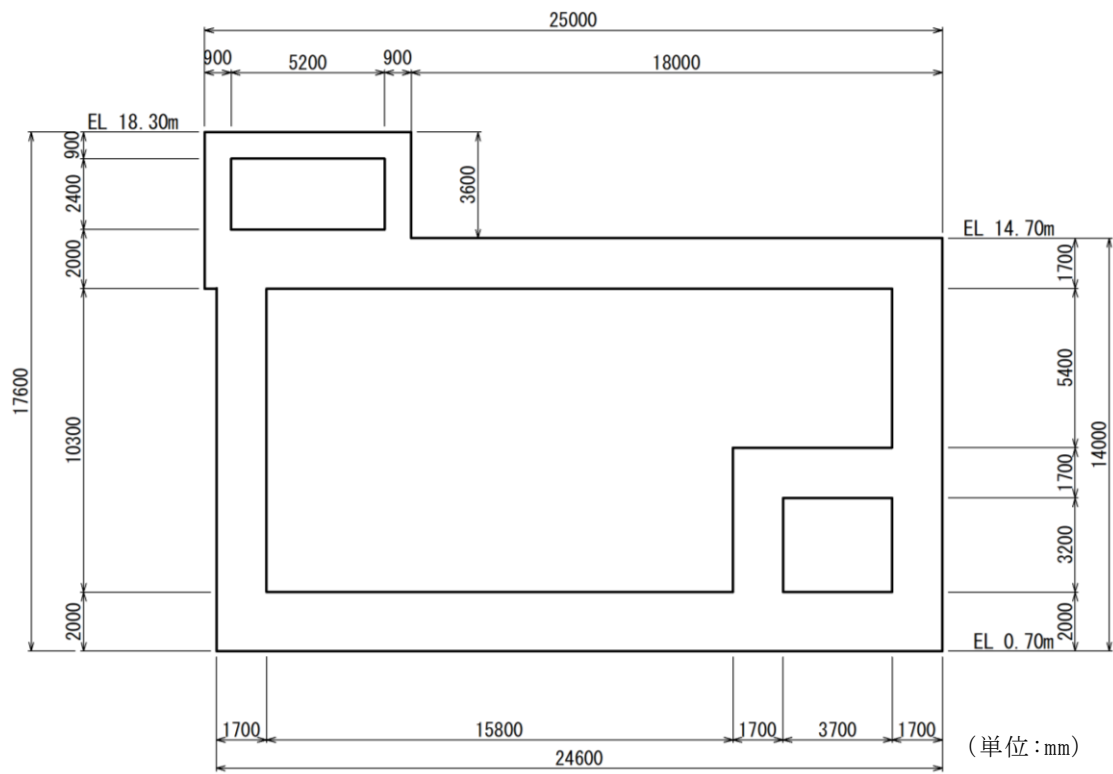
第 1 ベントフィルタ格納槽 断面図 (C-C 断面)
